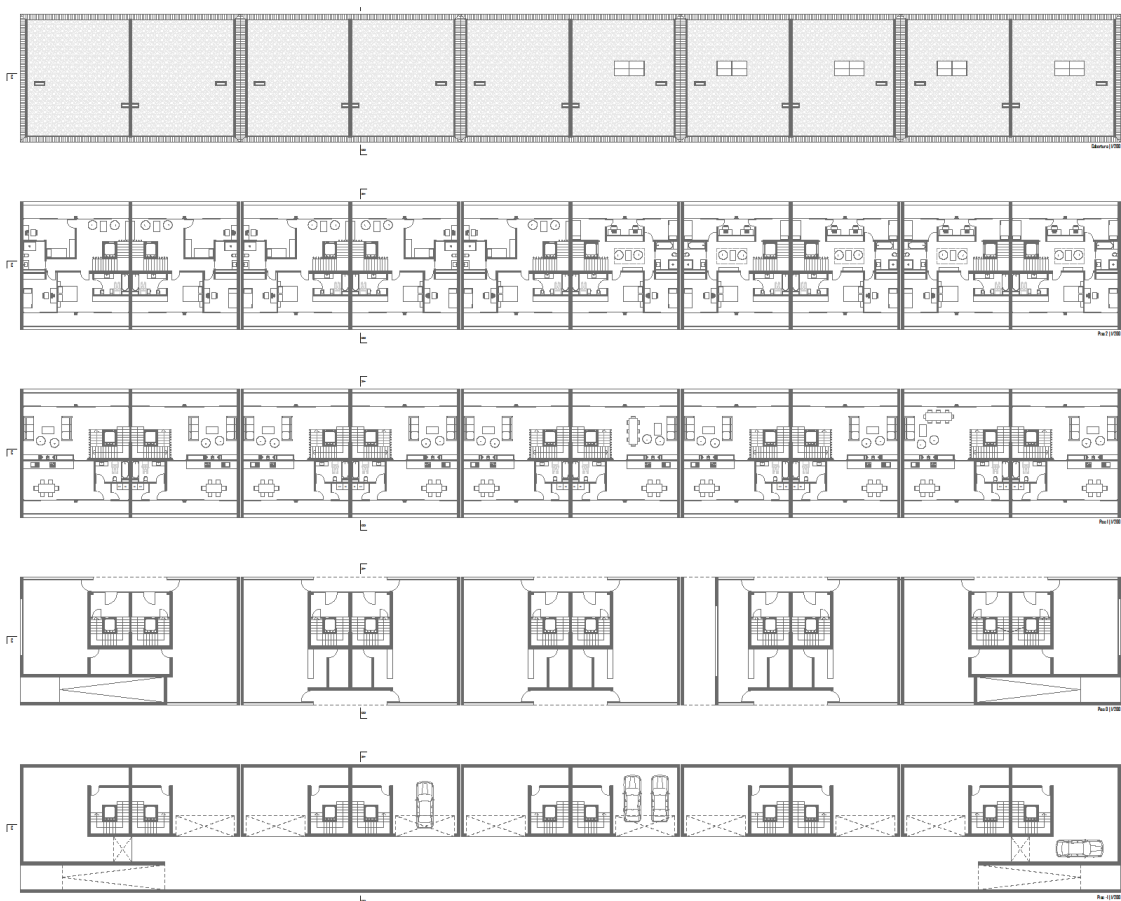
Proposta de Habitação unifamiliar em banda, plantas
